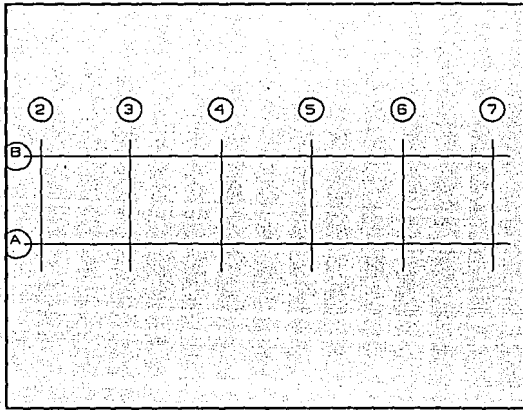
(b).- Modelo 2. Planta tipo
